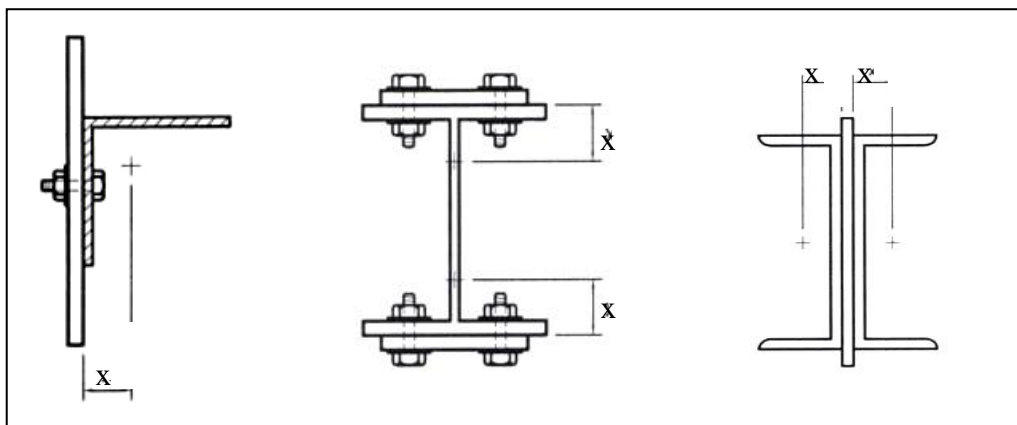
Distancia del centroide del área conectada al plano de la conexión
